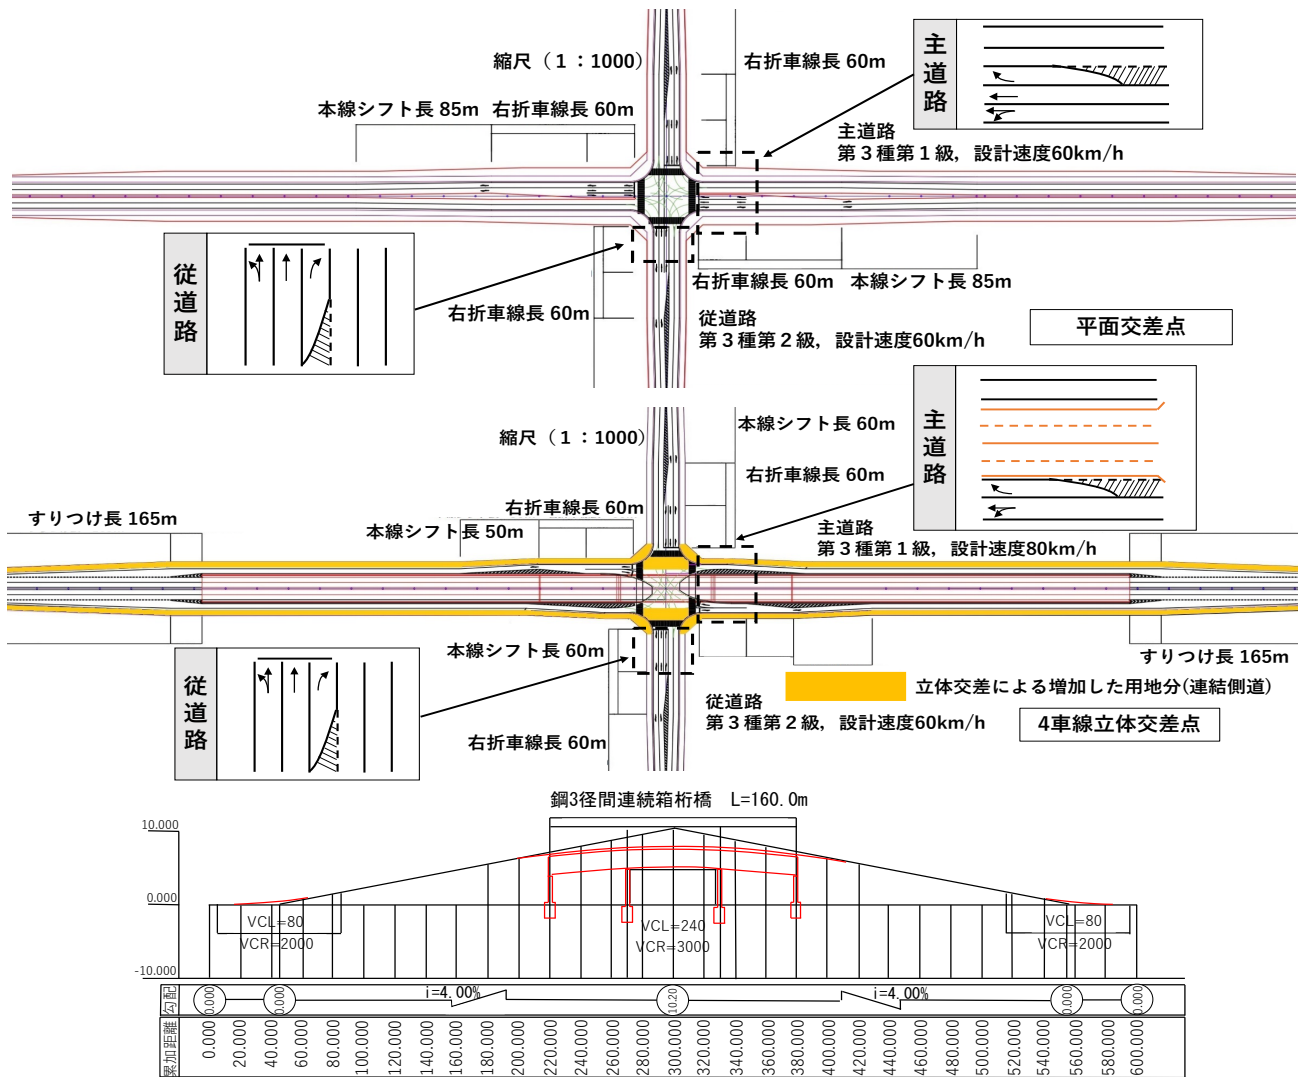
平面交差点の平面図および4車線立体交差点の平面図・縦断図（第3種）
